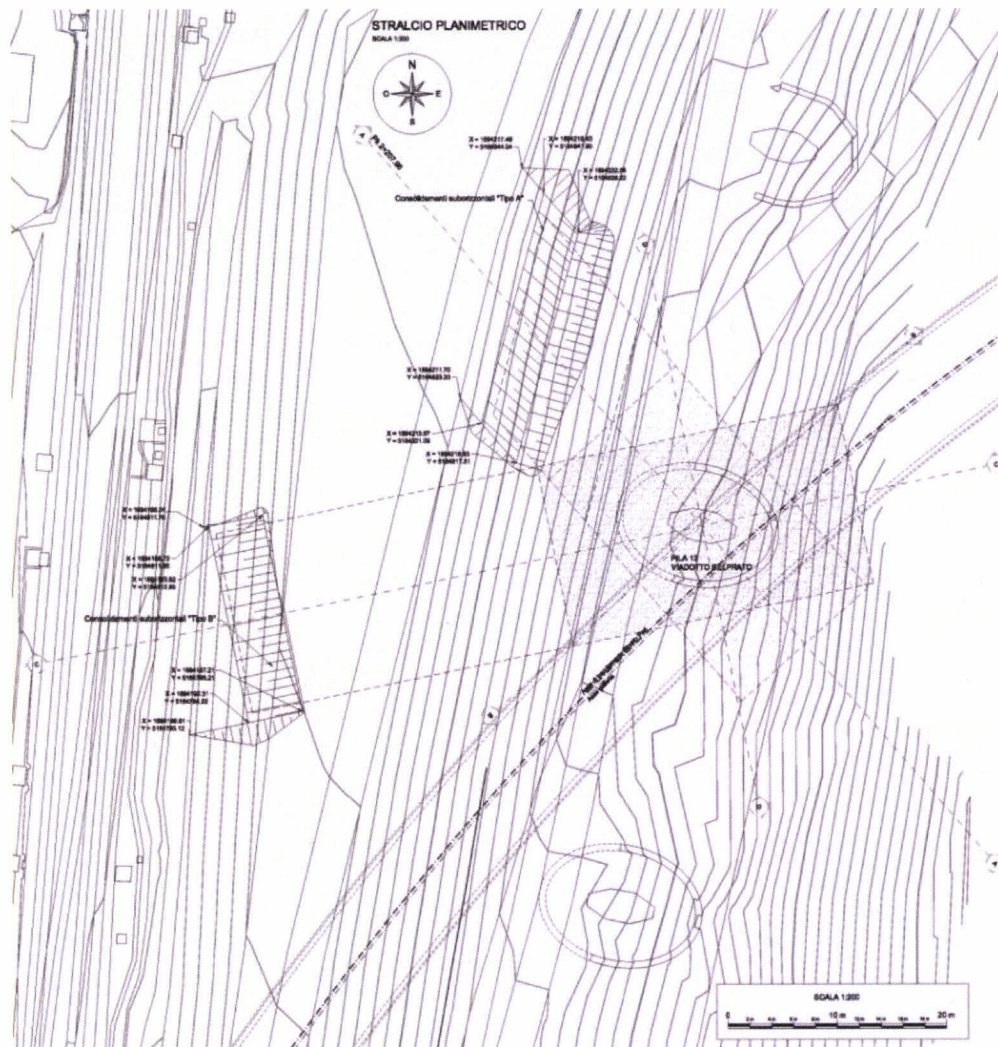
Planimetria zona interferita - geometrie dell'intervento
